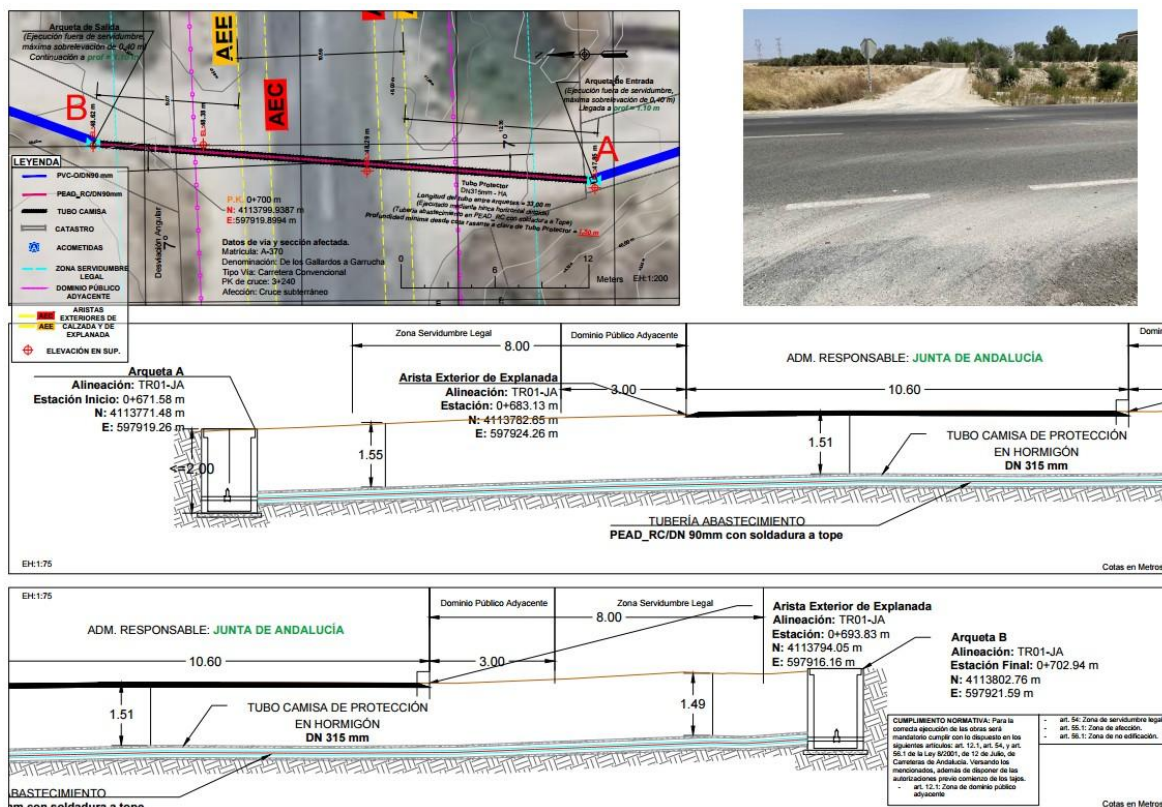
Zona de ejecución de la perforación horizontal dirigida bajo A-370. Tubería en PEAD-RC DN90mm mediante soldadura a tope.
